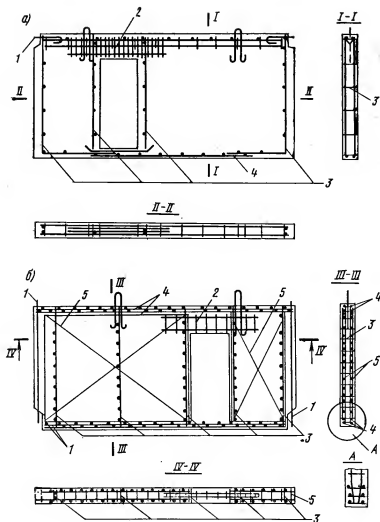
Варианты армирования внутренних несущих стеновых панелей
